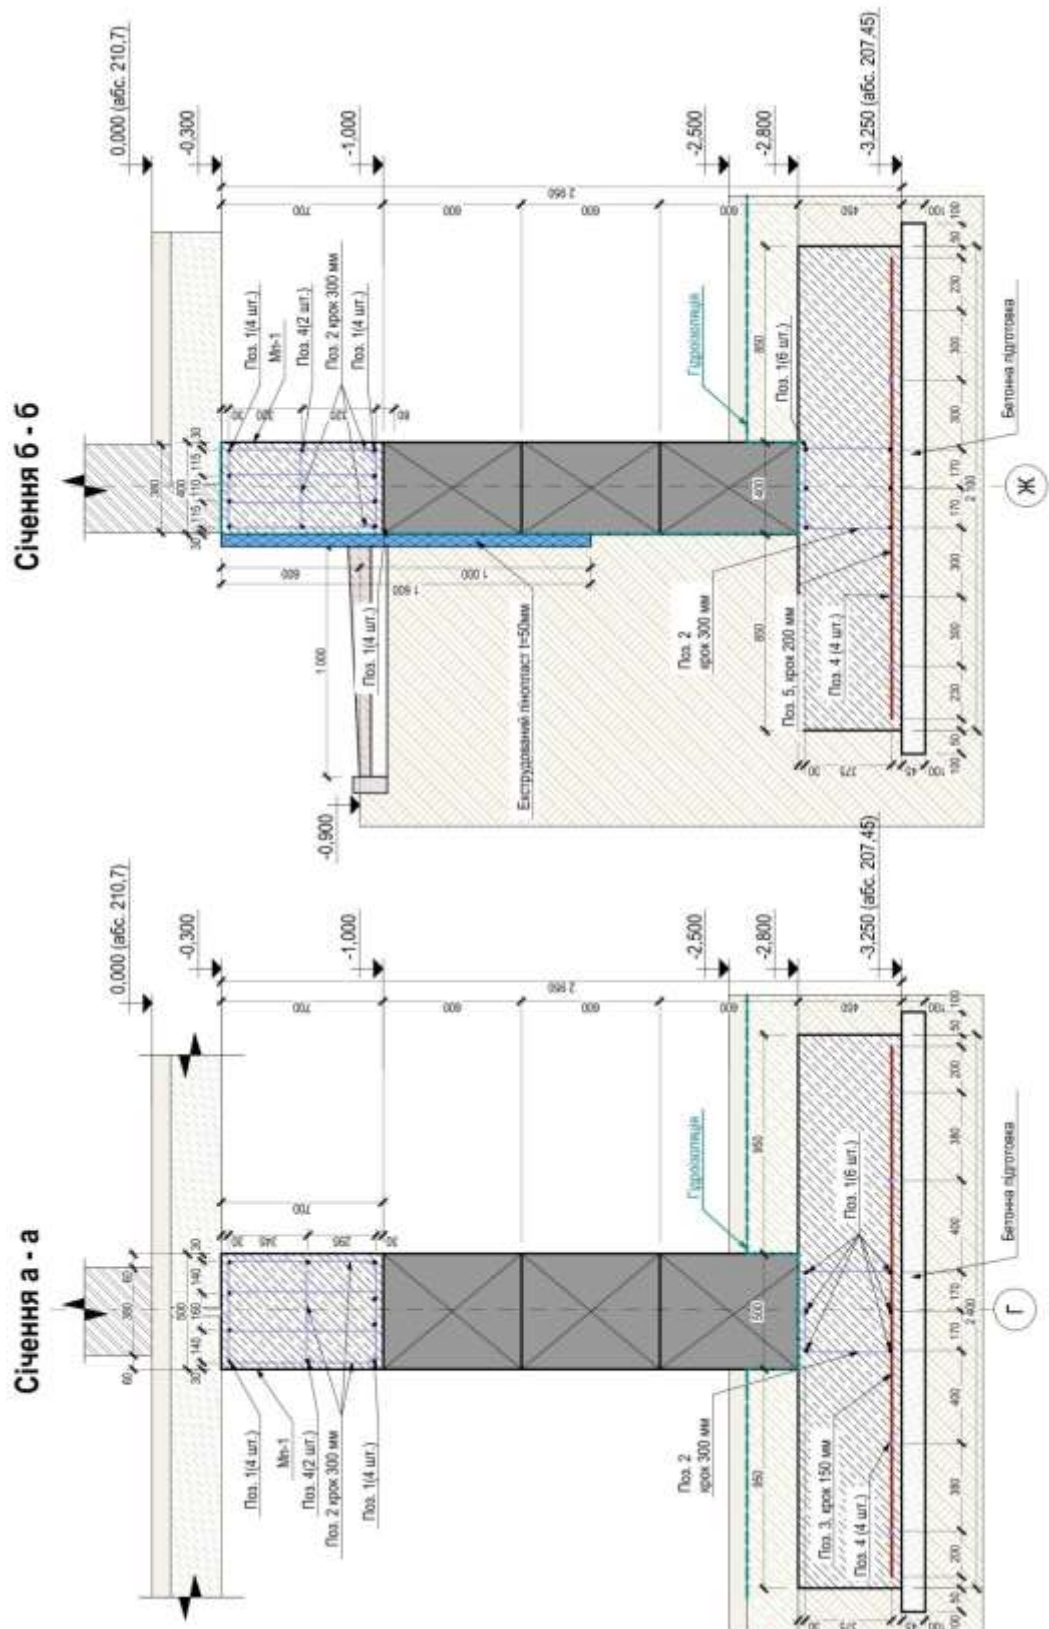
Фрагмент плану фундаментів будинку – січення а-а і б-б
